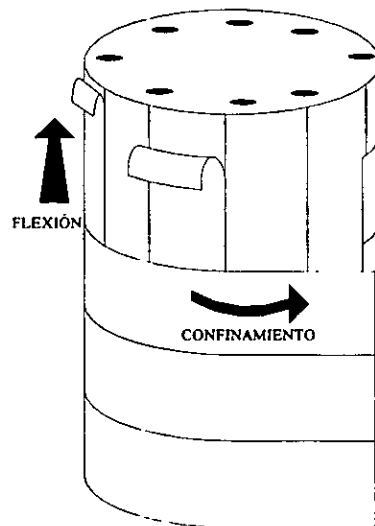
Orientación de los ELFC para refuerzo de columnas
